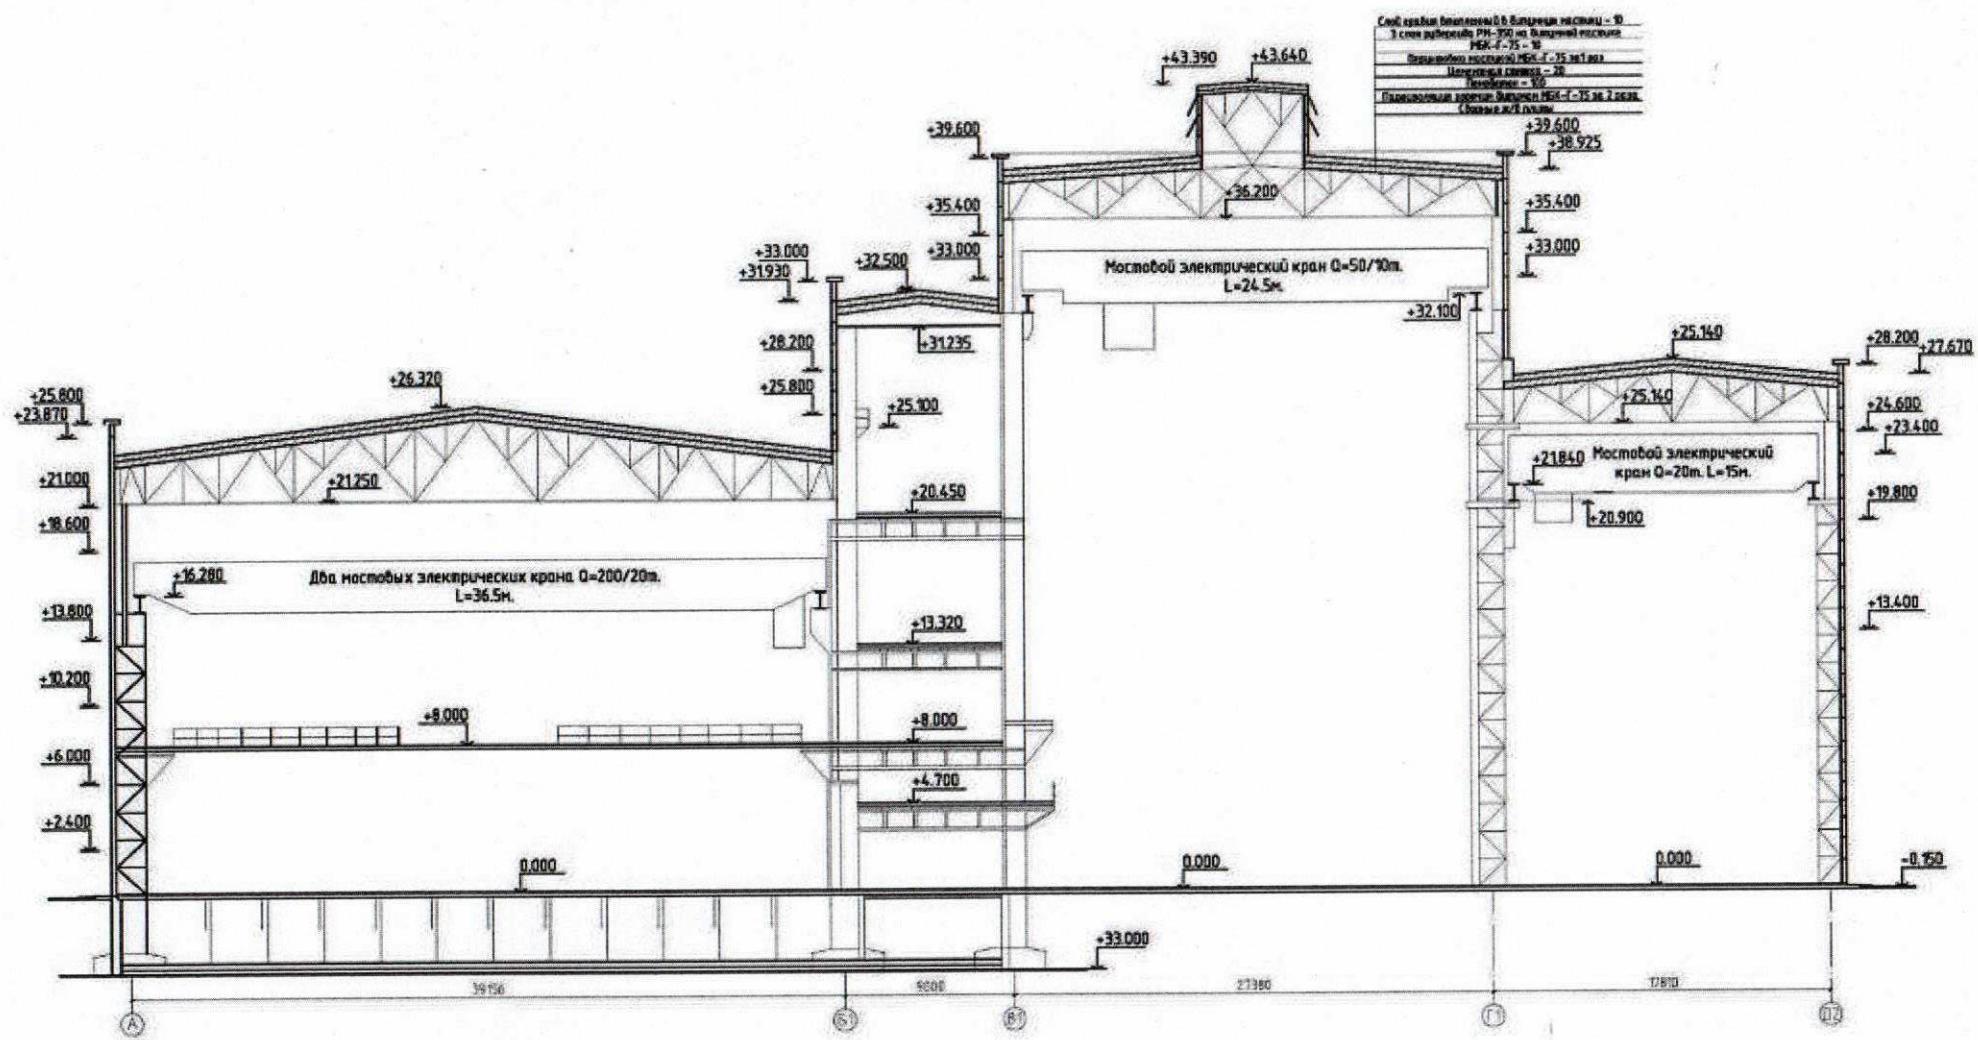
Поперечный разрез здания главного корпуса.
